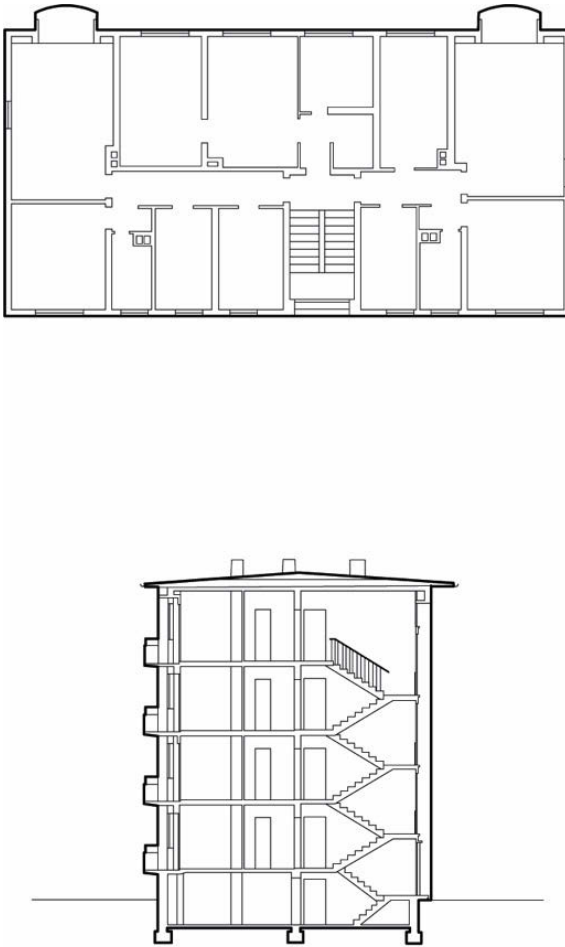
Grundriss & Schnitt Bestand, Fritz-Kissel-Siedlung
